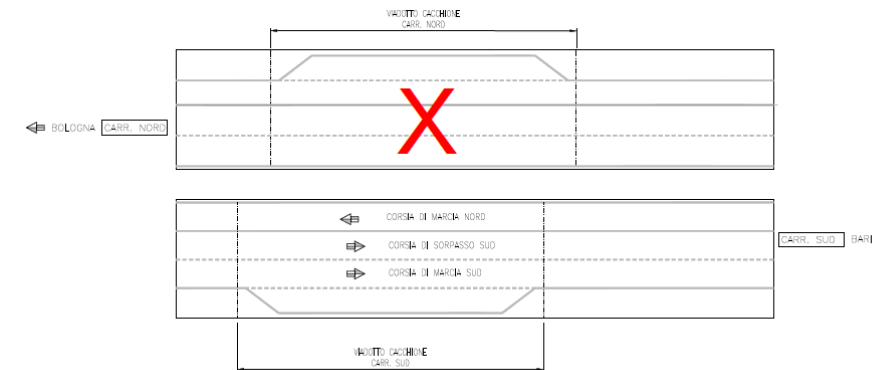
Sezione trasversale e schema planimetrico: Fasi 5 e 6
